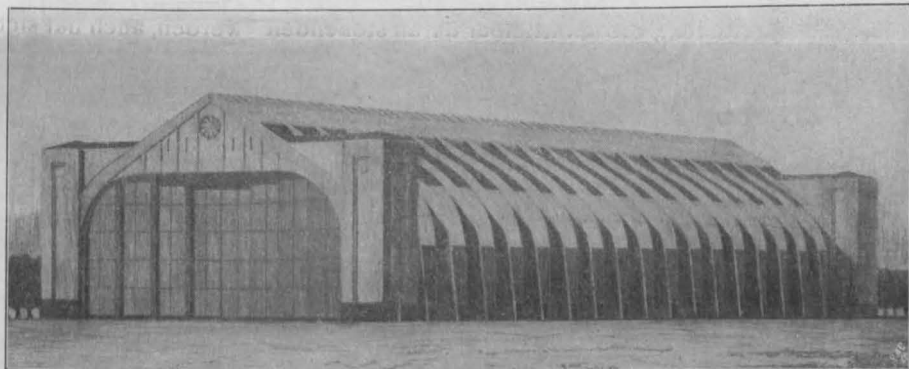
Schaubild der Halle. Entwurf der A.-G. für Beton- und Monierbau in Stuttgart.
